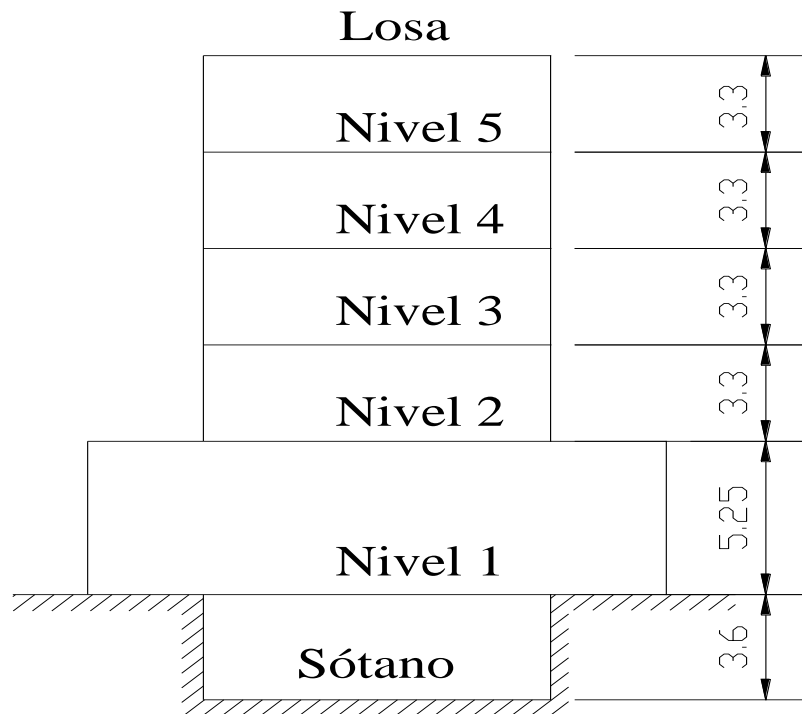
13 Esquema de la elevación lateral sur-norte.
